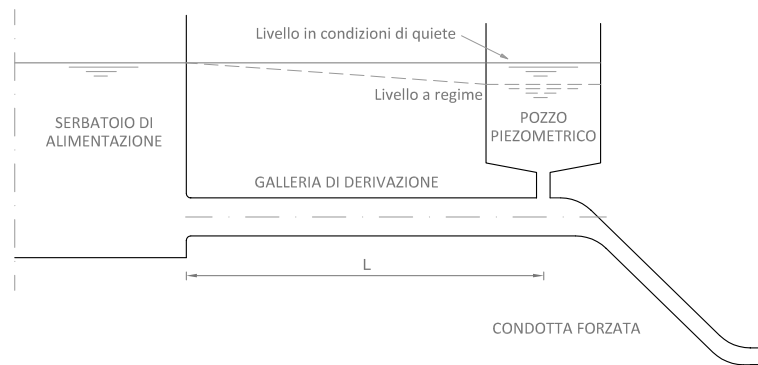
Esempio schema d'impianto con pozzo piezometrico.
